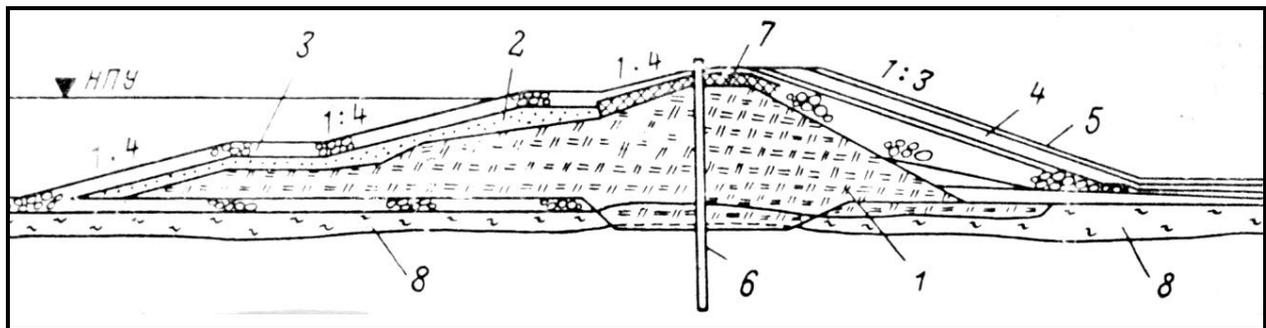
Насыпная плотина Иреляхского гидроузла на р. Ирелях, 1964 г.
